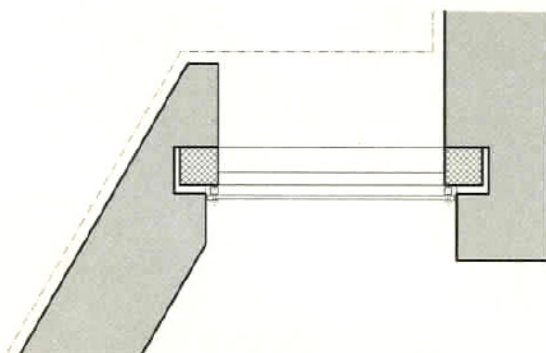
Carpinterías metálicas embebidas en el muro. Refuerzo de toba y cal actuando como premarco.
